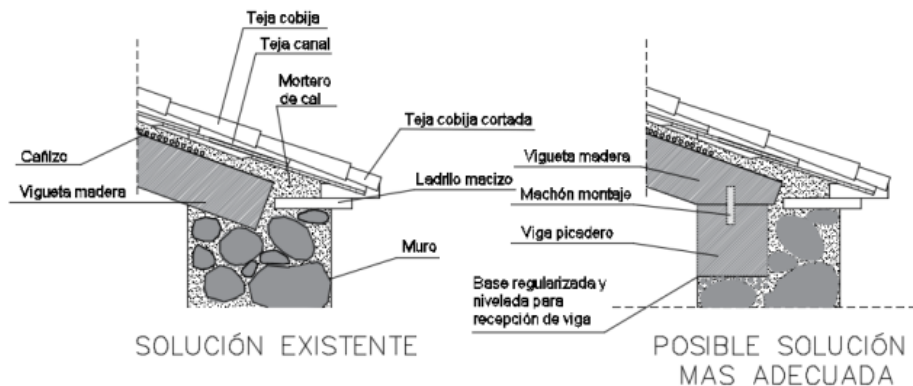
Detalle encuentro cubierta- muro. 2016. Fuentes propias
